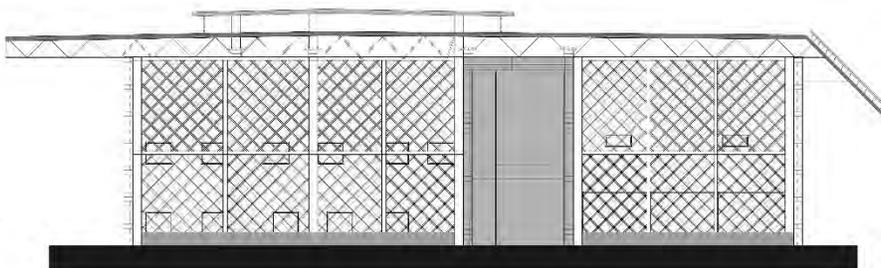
Fachada Oeste de nuestro proyecto, muestra la doble cubierta inspirada en el trabajo del Arquitecto Kéré
